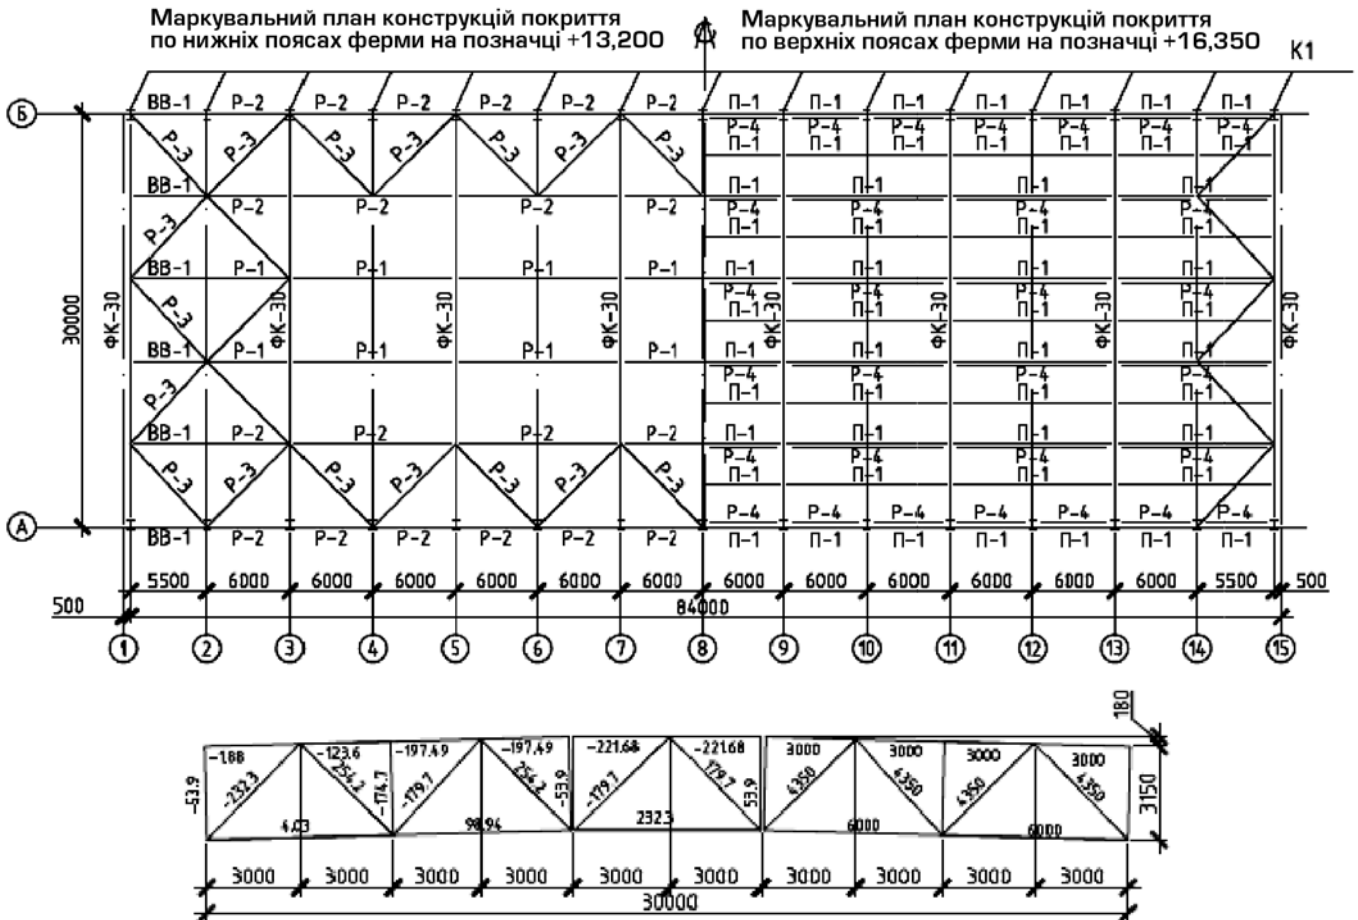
Маркувальний план по верхніх та нижніх поясах ферм покриття та монтажна геометрична схема ферми
